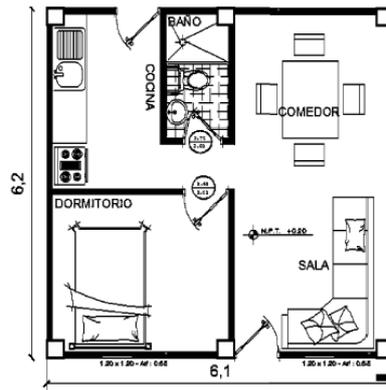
Planta arquitectónica de la vivienda de iteres social, La Pradera
